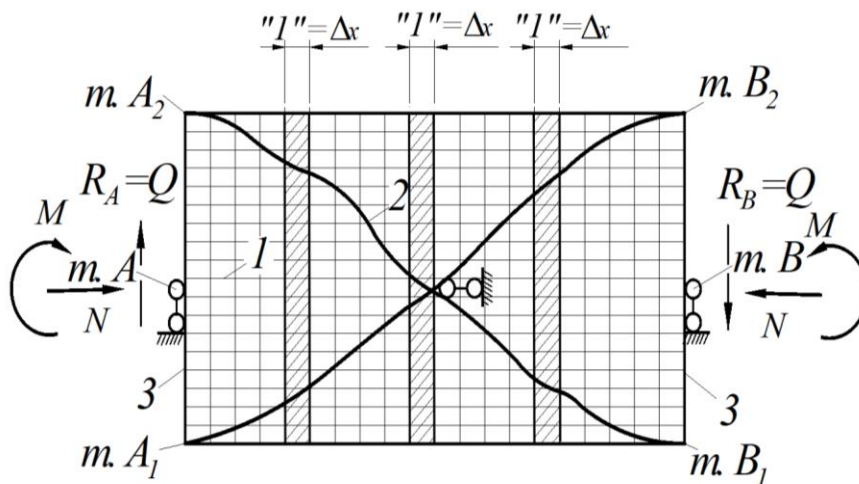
Модель плосконапряженного железобетонного элемента с наклонными (перекрестными) трещинами для определения жесткости
